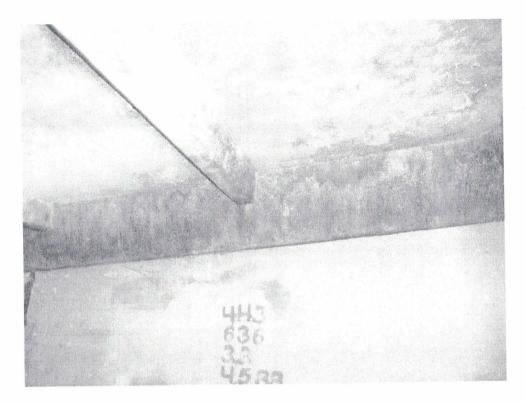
Фрагмент плиты покрытия. На ребристых плитах покрытия скопления конденсата, потеки, плесень, грибок.
